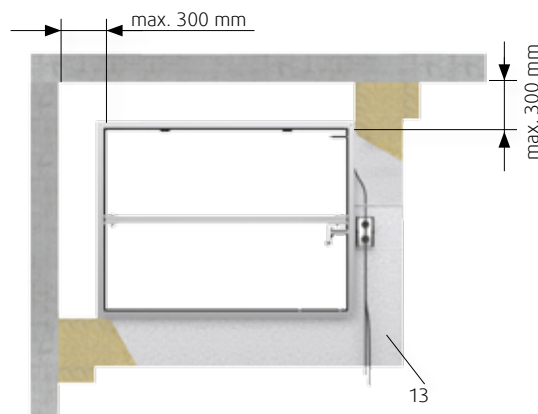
Instalace mimo/na požárně dělící konstrukci v blízkosti stropu
